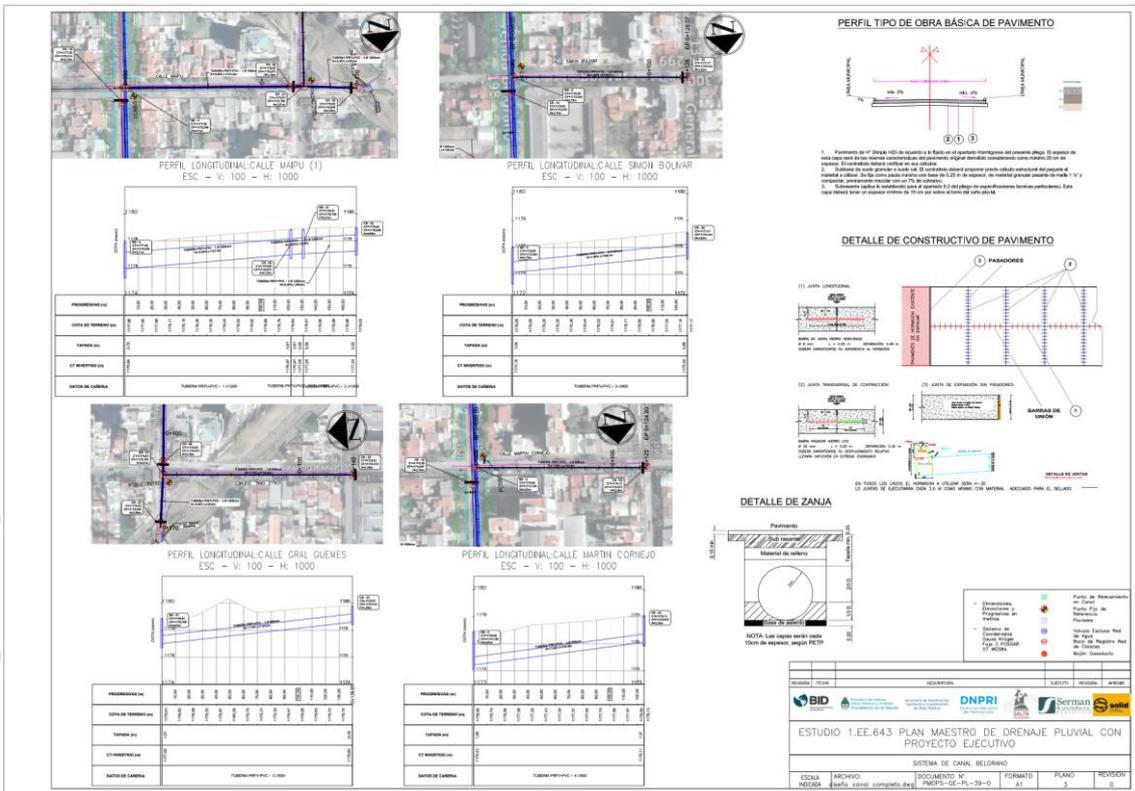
Plan Maestro de drenaje Pluvial – Canal secundario calle Belgrano y canales terciarios
